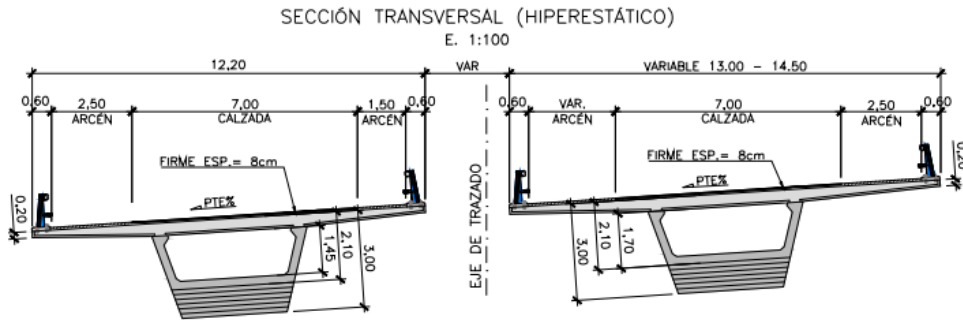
Sección tipo Viaducto de Beas (en vano 3)
